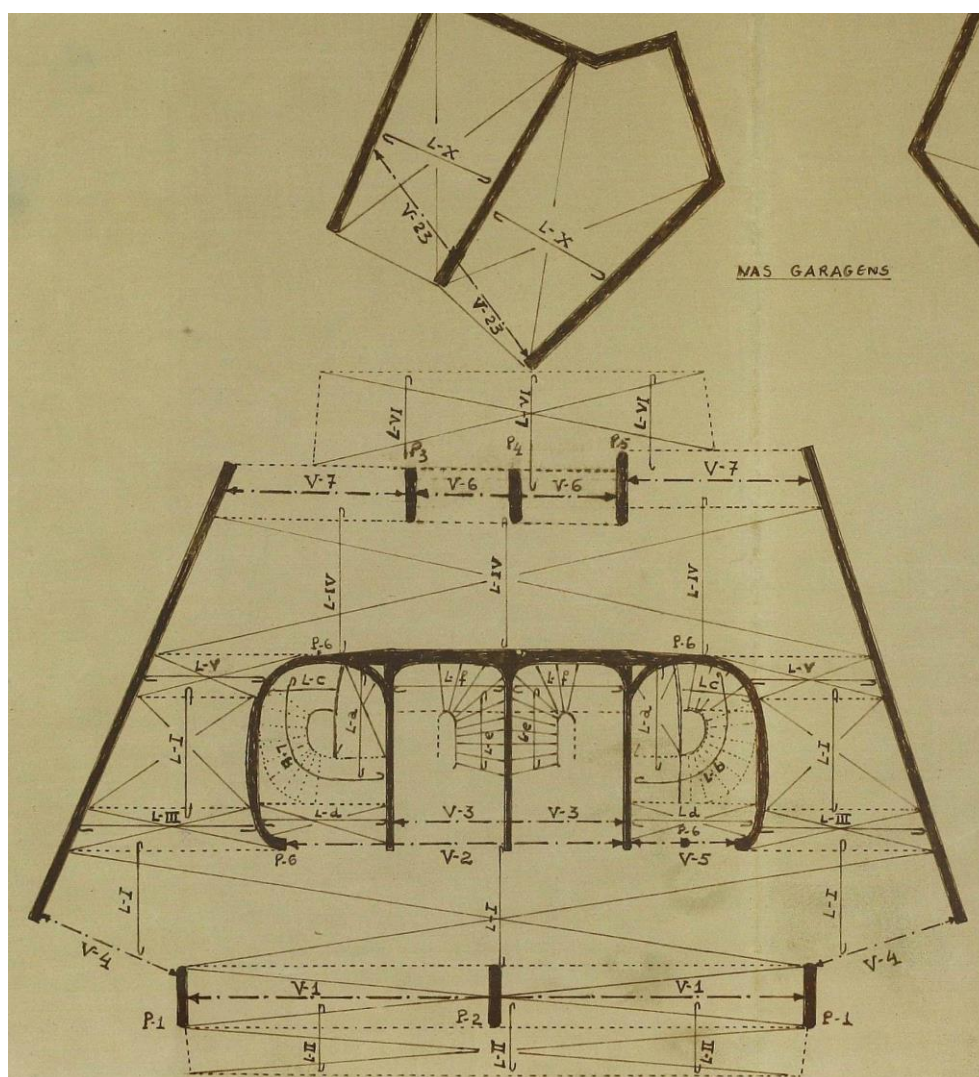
Planta estrutural do rés-do-chão conforme L.O. 228/68.
